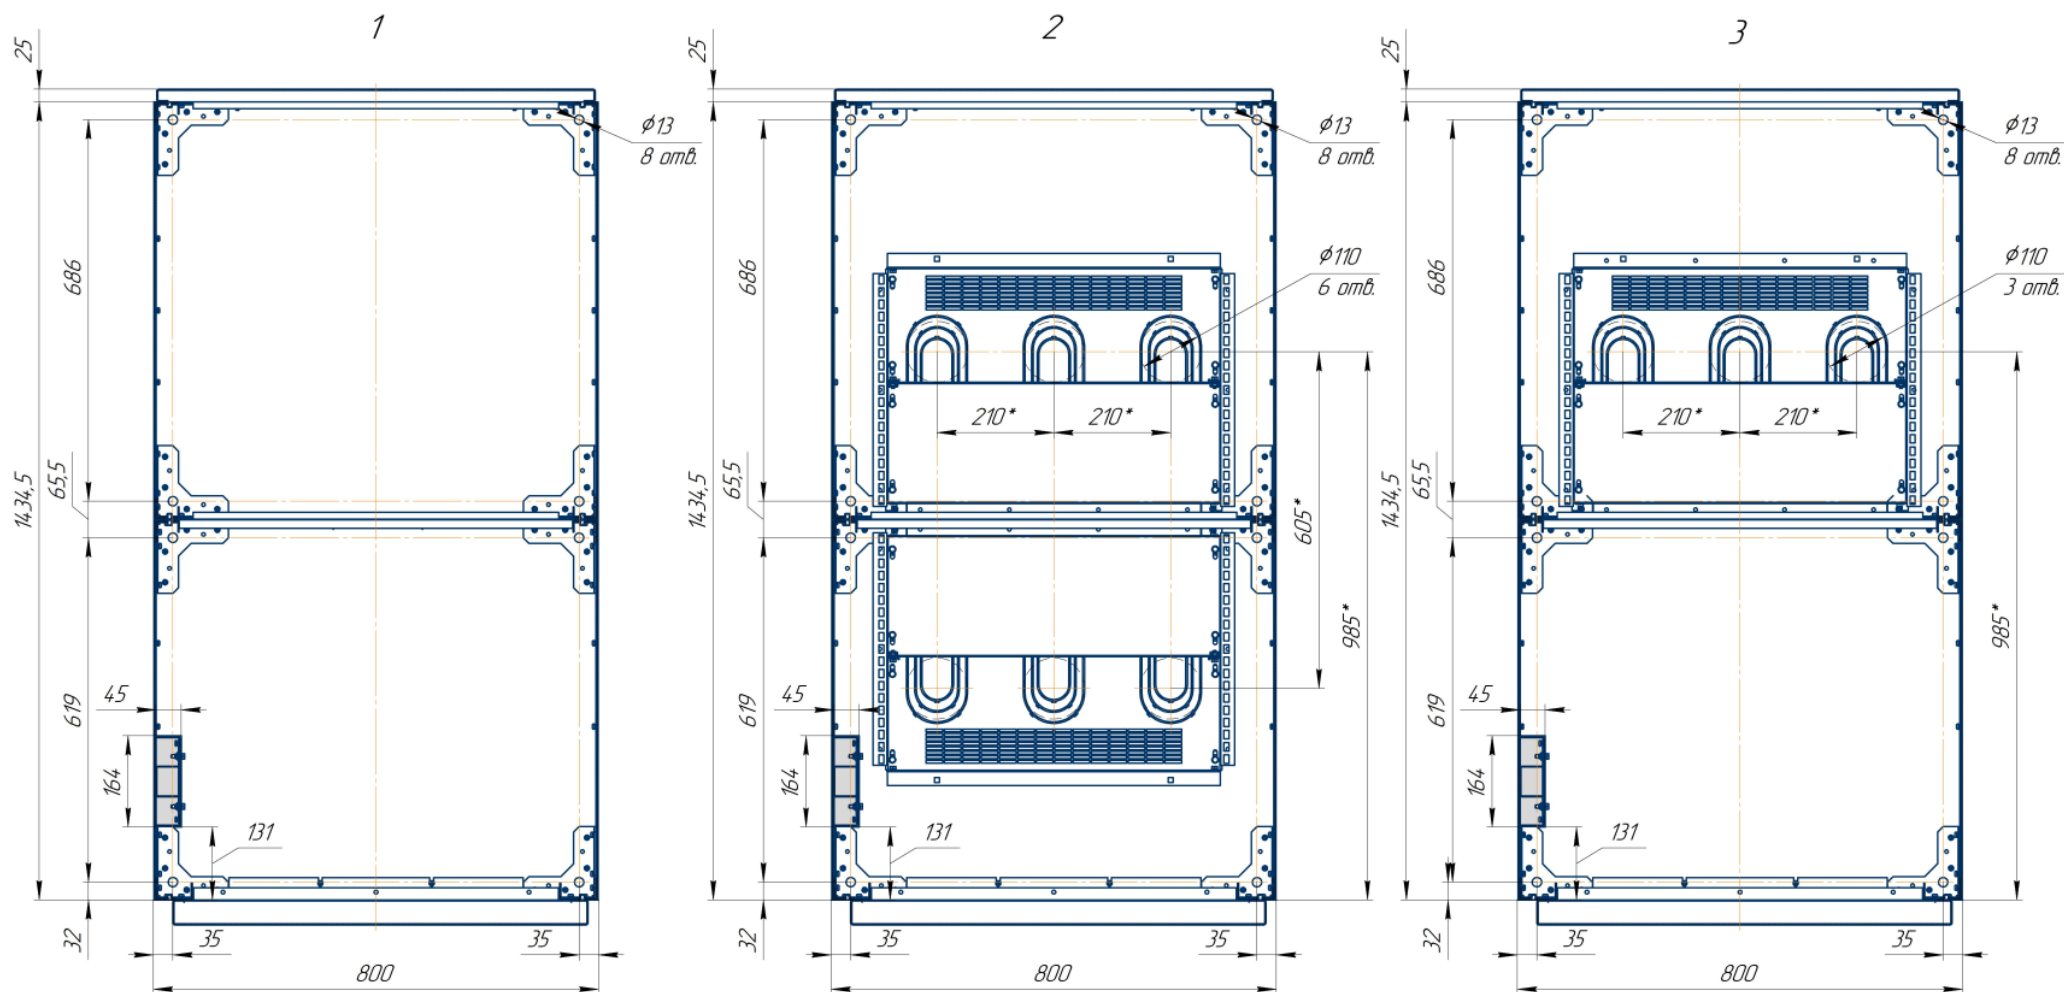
Установка КPY-70-BLISS шириной 800мм на фундамент
